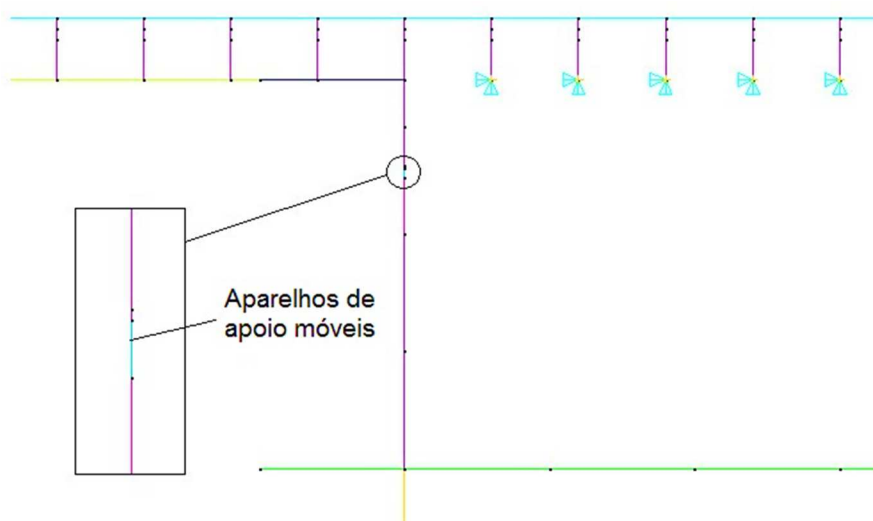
Pormenor da modelação dos aparelhos de apoio móveis sobre o encontro E2.
